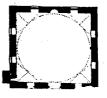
مسقط أفقى لمسجد حاجى شهاب الدين باشا في أدرنة (عن كوران).
